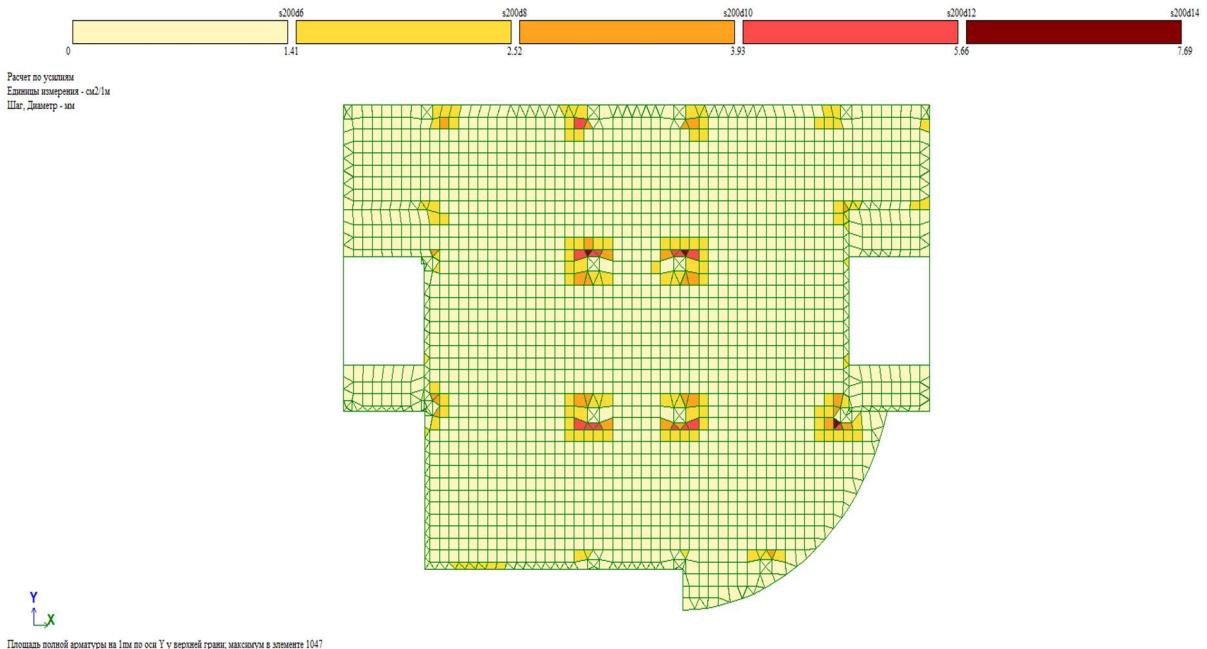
Верхнее армирование перекрытия этажа по оси У
